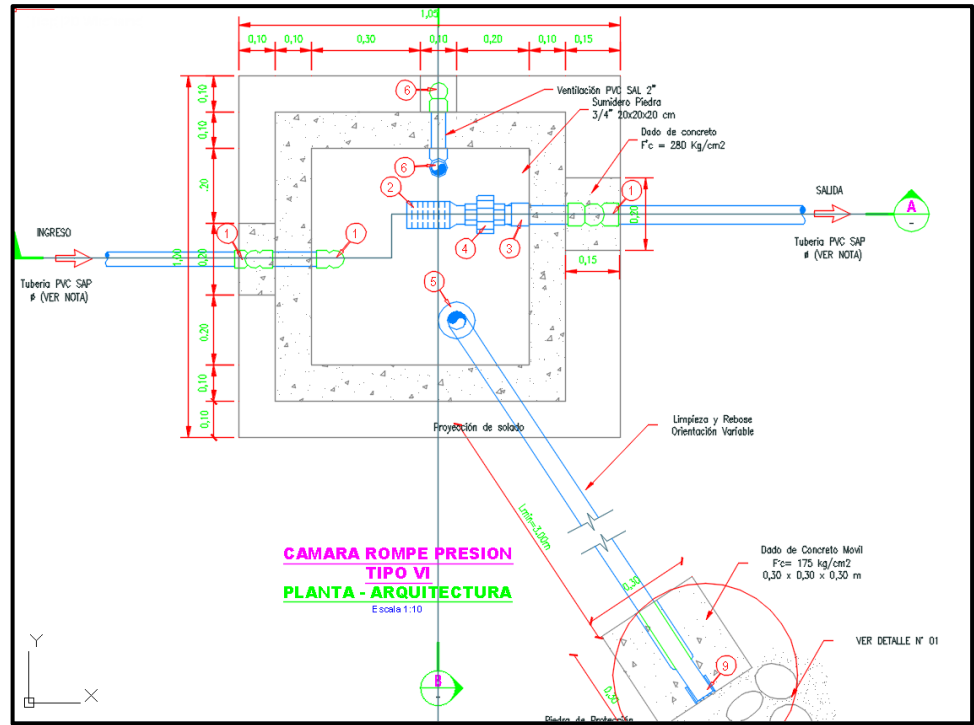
Planteamiento de Cámara Rome Presión Tipo VI en Planta
